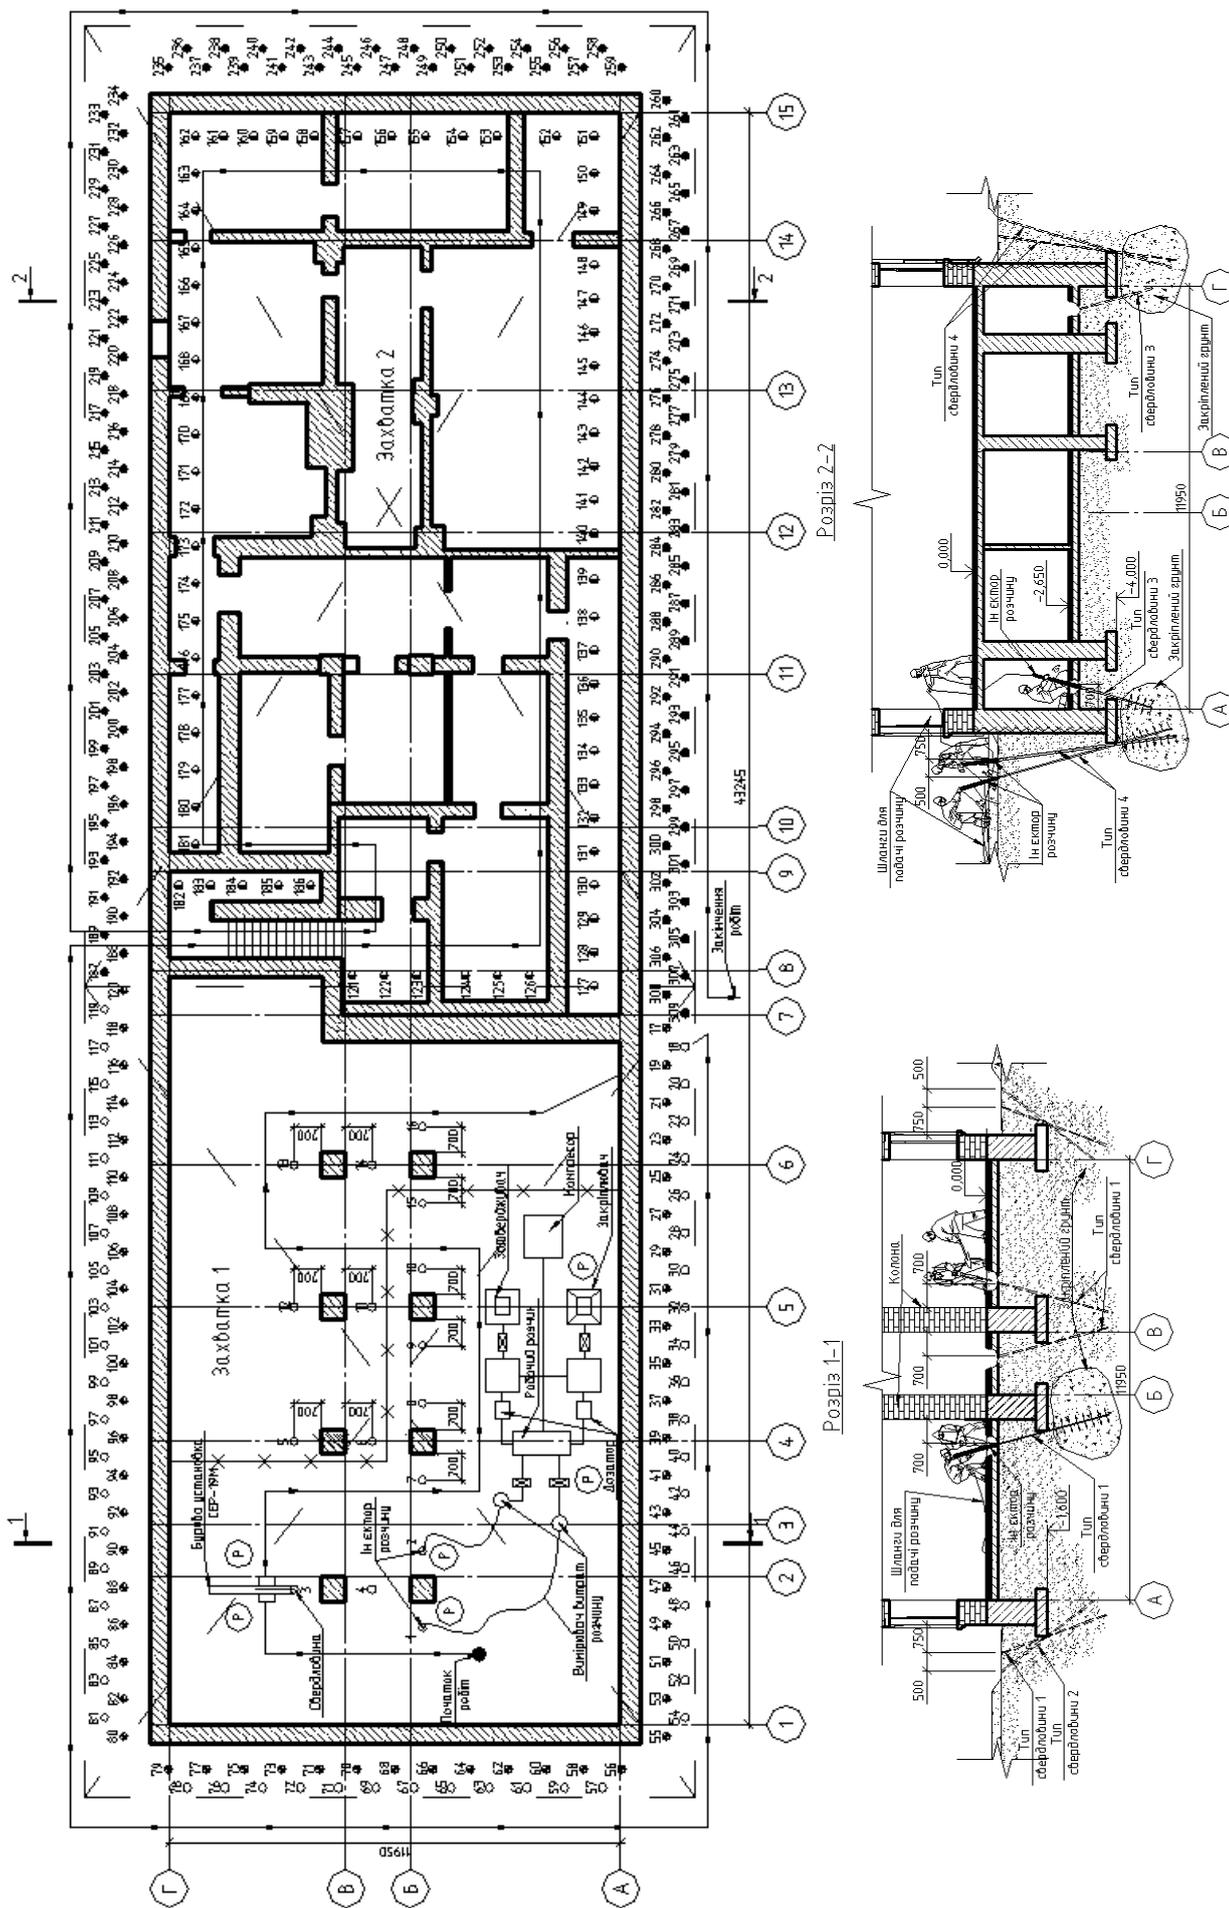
Схема виконання робіт по усилению фундаментов грунтов основания под фундаментами здания.
